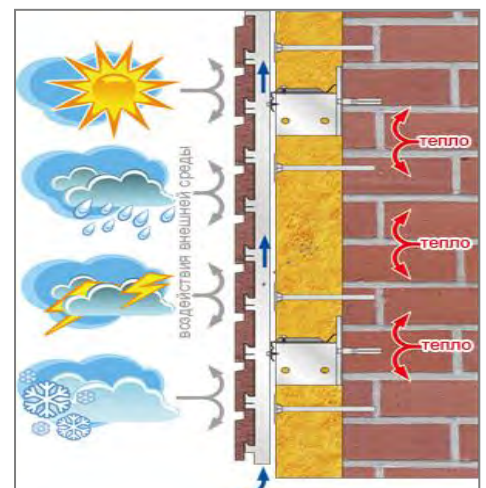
Конструктивна схема збірної системи із стояково-ригельним кріпленням зовнішнього опоряджувального захисного шару
